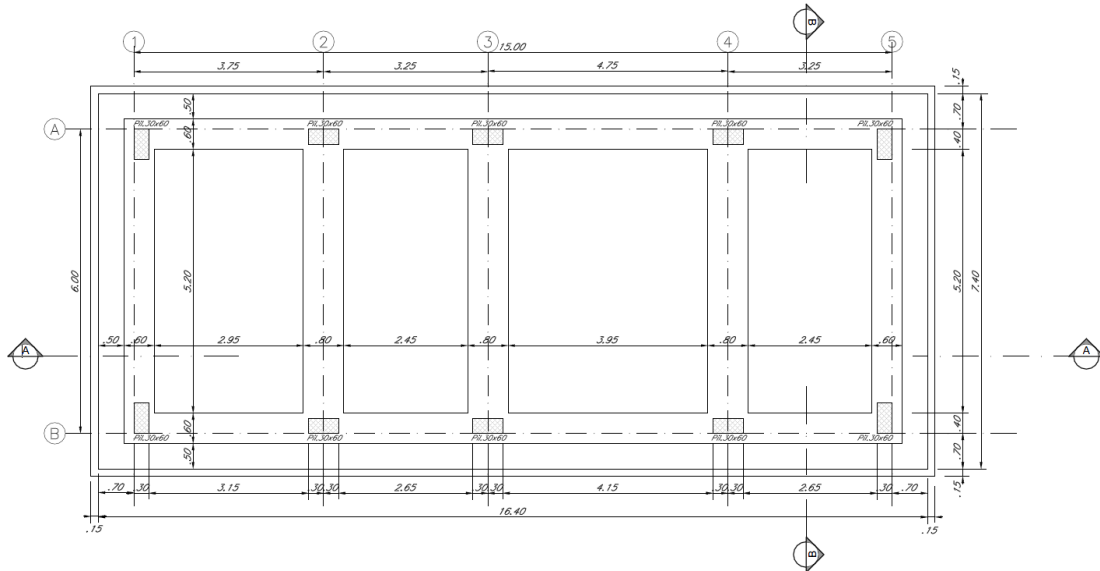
Fabbricato tipo B - Carpenteria fondazione
